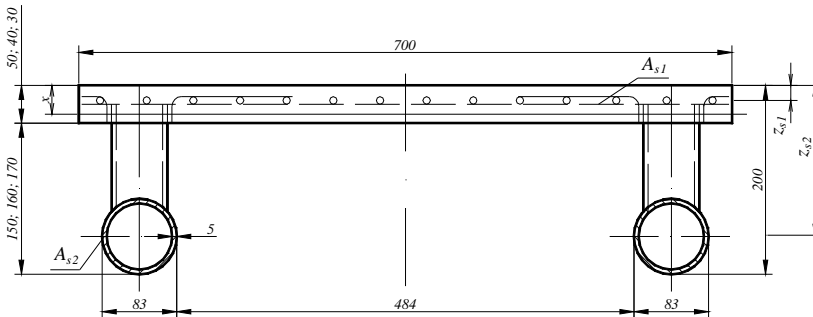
Розрахункова схема сталезалізобетонної плити з армуванням трубами серій Б-3-1, Б-3-2, Б-3-3
